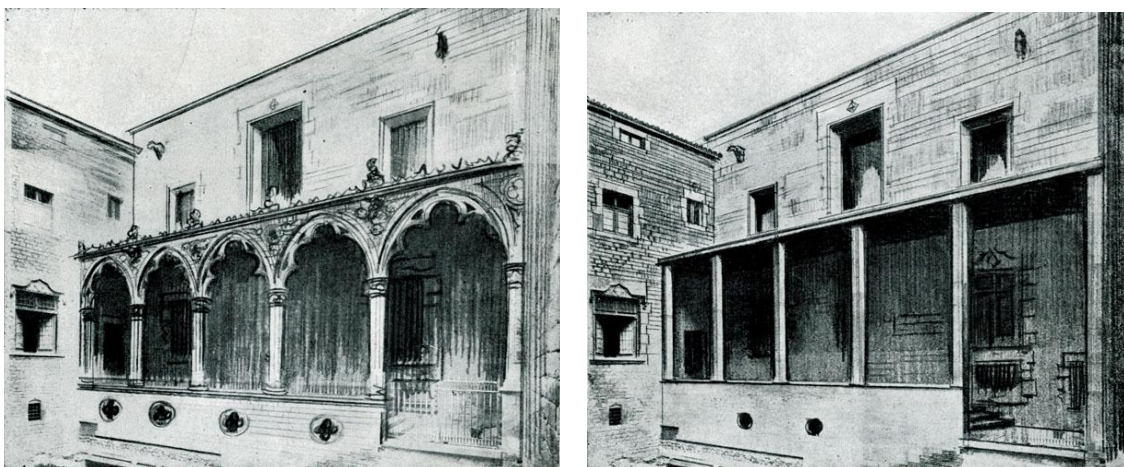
> Las dos propuestas antes de construir el pórtico:
